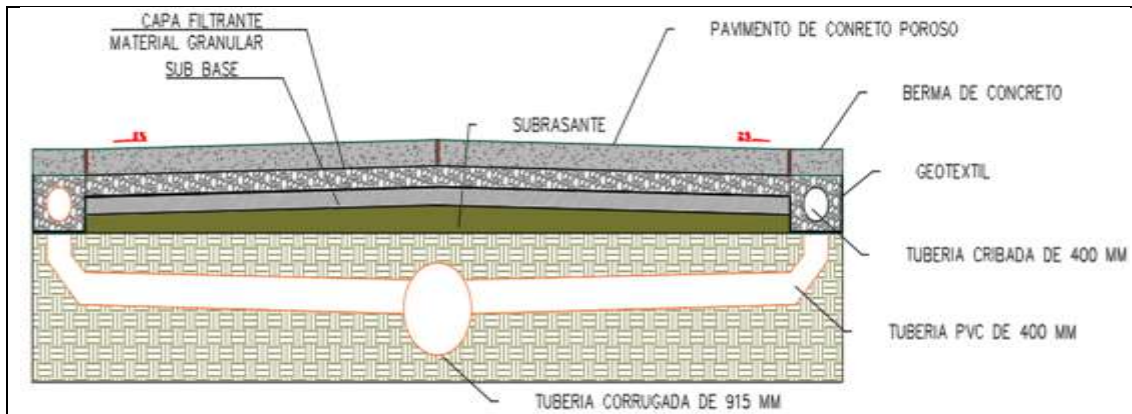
Detalle de pavimento de concreto poroso de acuerdo con los cálculos
